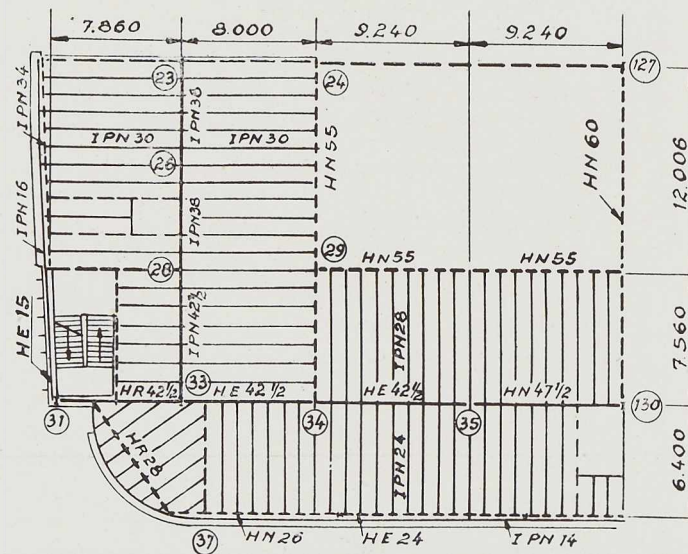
Dispositions générales des planchers adoptés pour les magasins.
